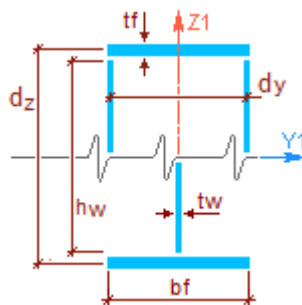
Схема профиля Двутавр сварной симметричный/Коробка сварная симметричная
